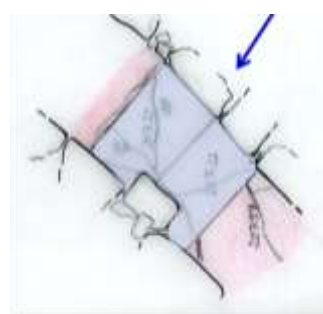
Vista de plano da caixa de decantação de sedimentos do aqueduto UE003 (UAUM).
